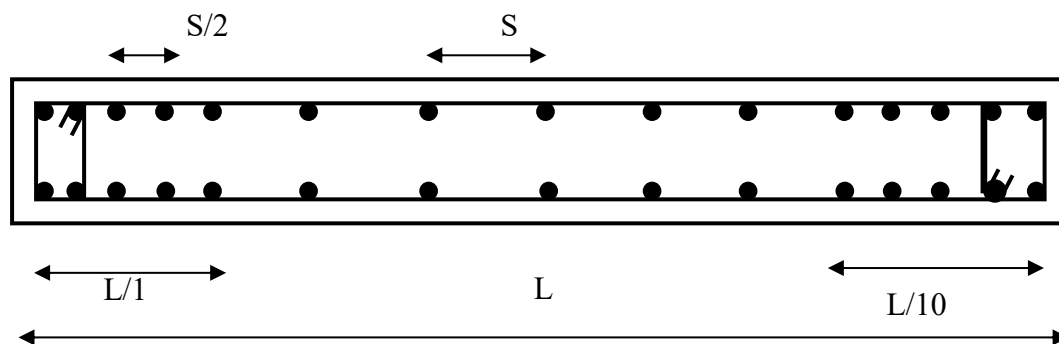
Disposition des armatures verticales (vue en plan)
